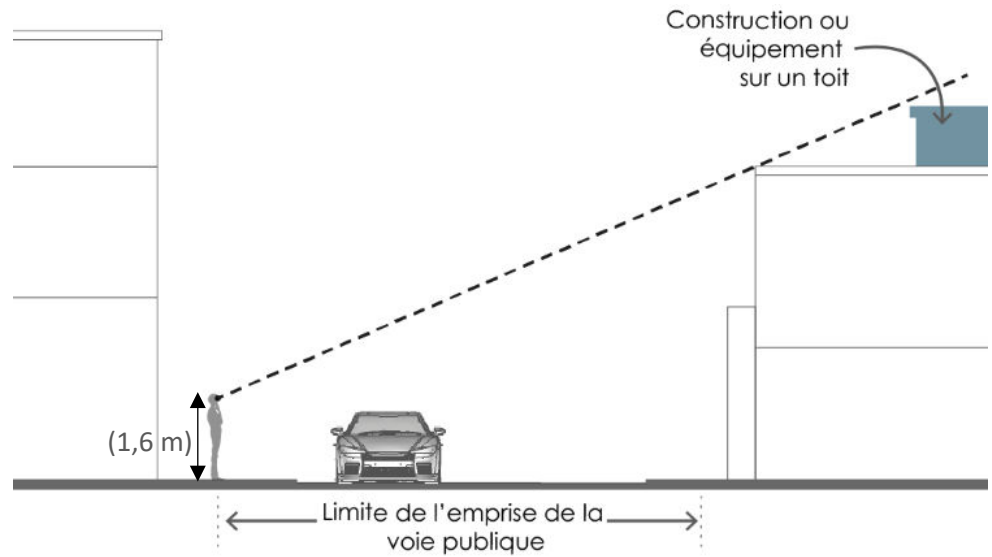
Visibilité d'une construction ou d'un équipement sur un toit à partir du domaine public.
